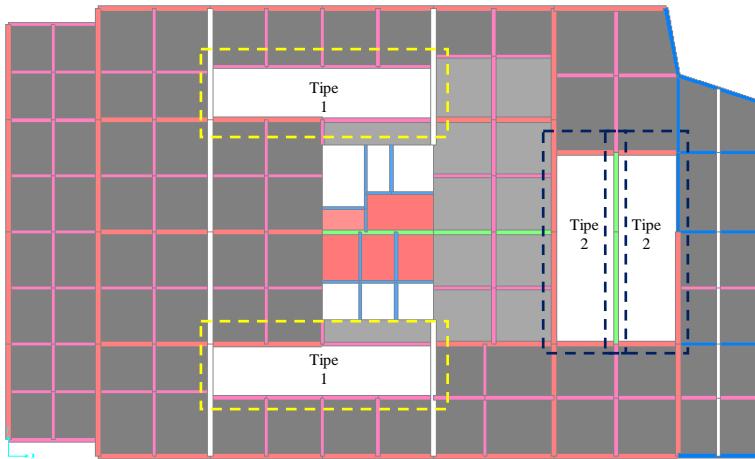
14 Denah Penulangan Struktur Tangga Area 1
